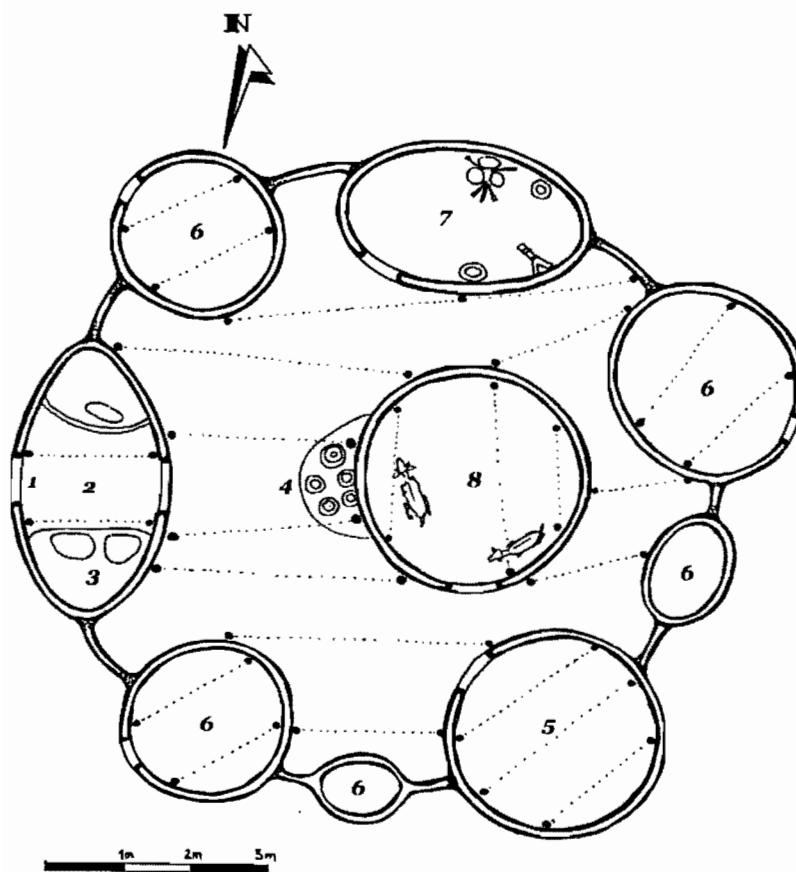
Vue en plan Rez-de-chaussée : vieille Takienta du feu Santy.
